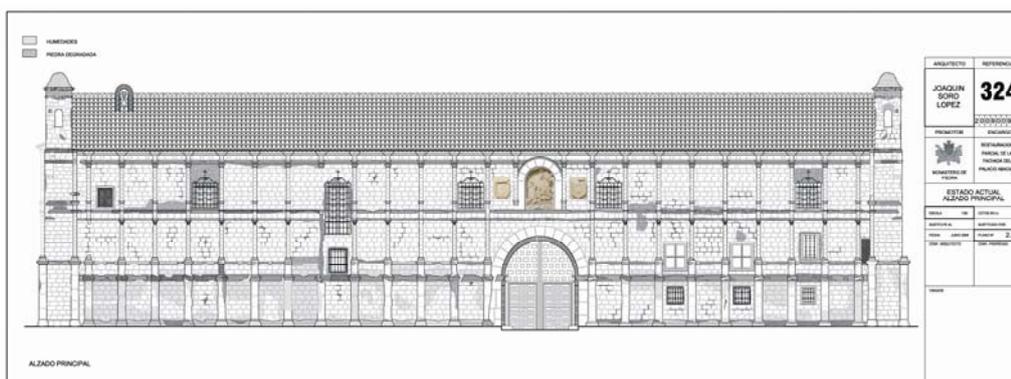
(Proyecto JUN 2009, plano 2.3) ESTADO ACTUAL. ALZADO PRINCIPAL
